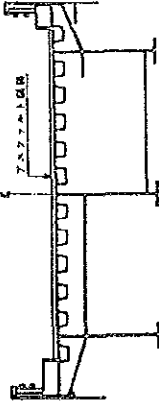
標準断面図 (プレキャストコンクリート床版)
